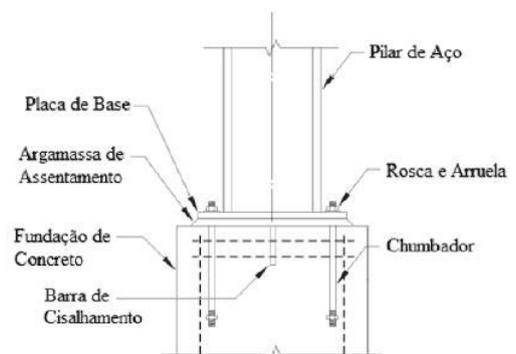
Ilustração de composição pilar e bloco de coroamento da fundação.
